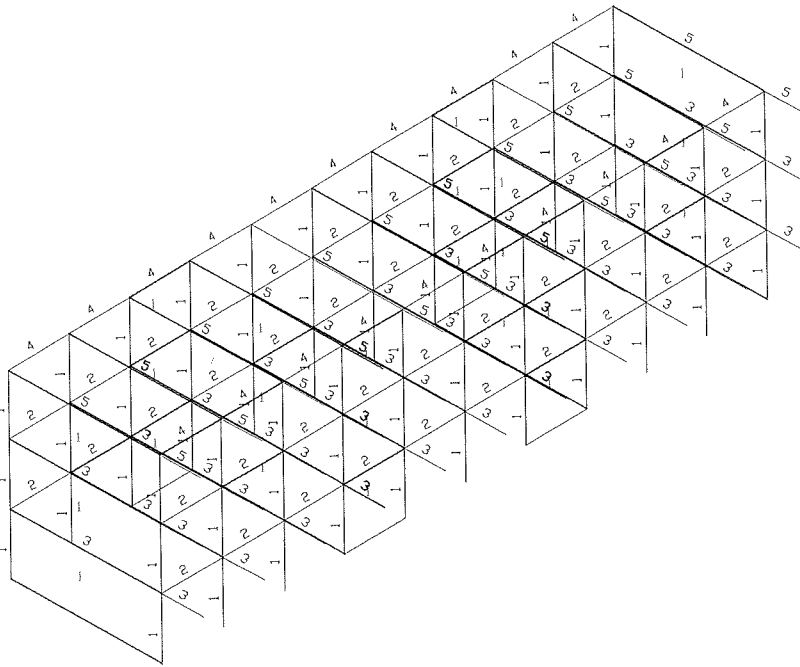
Sección tridimensional del MÓDULO A donde se muestran los elementos estructurales caracterizados con números (Apéndices 1 y 3). El número de vigas y columnas en color negro y de muros de cortante en color azul.
